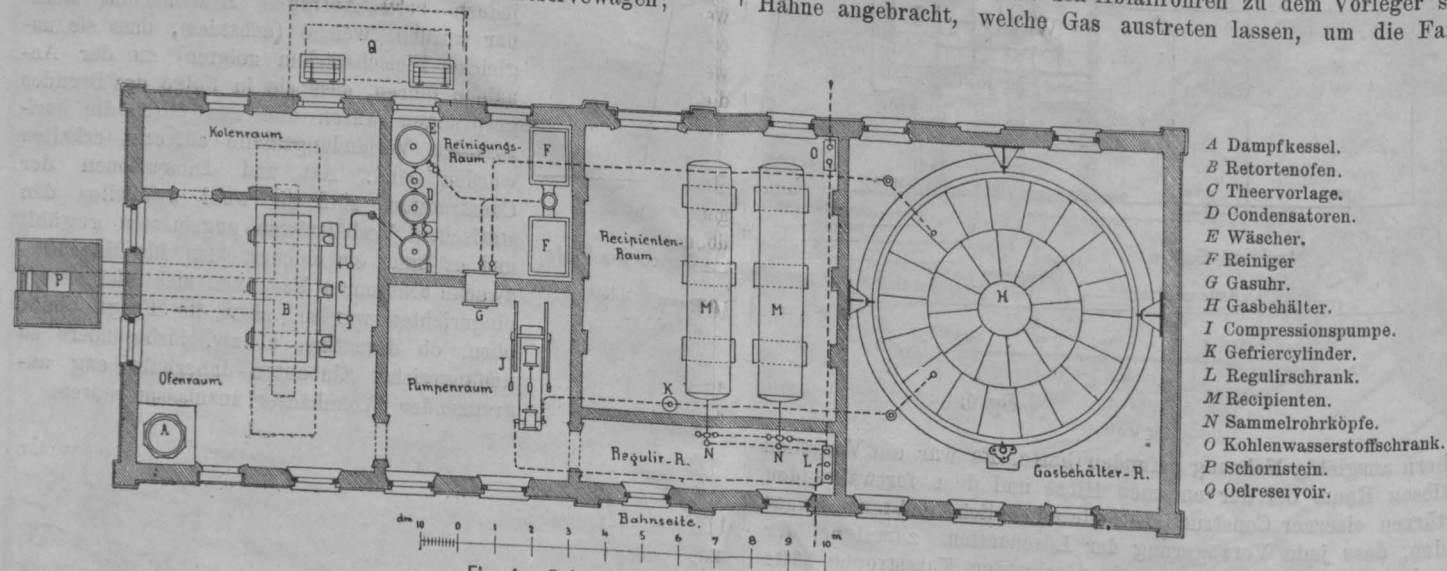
Oelgasanlage, — Grundriss.
